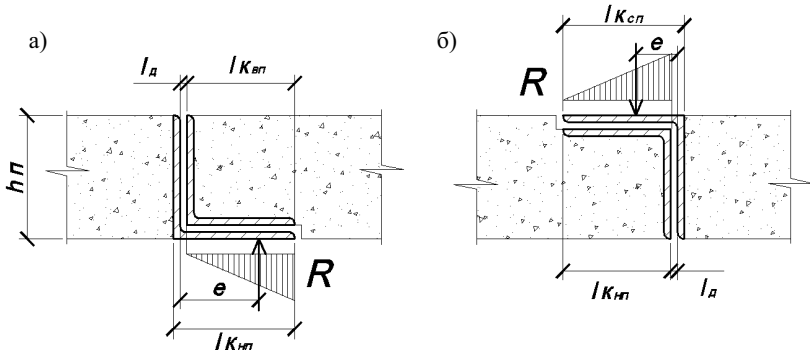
Схеми стиків елементів збірного сталезалізобетонного безбалкового перекриття:
